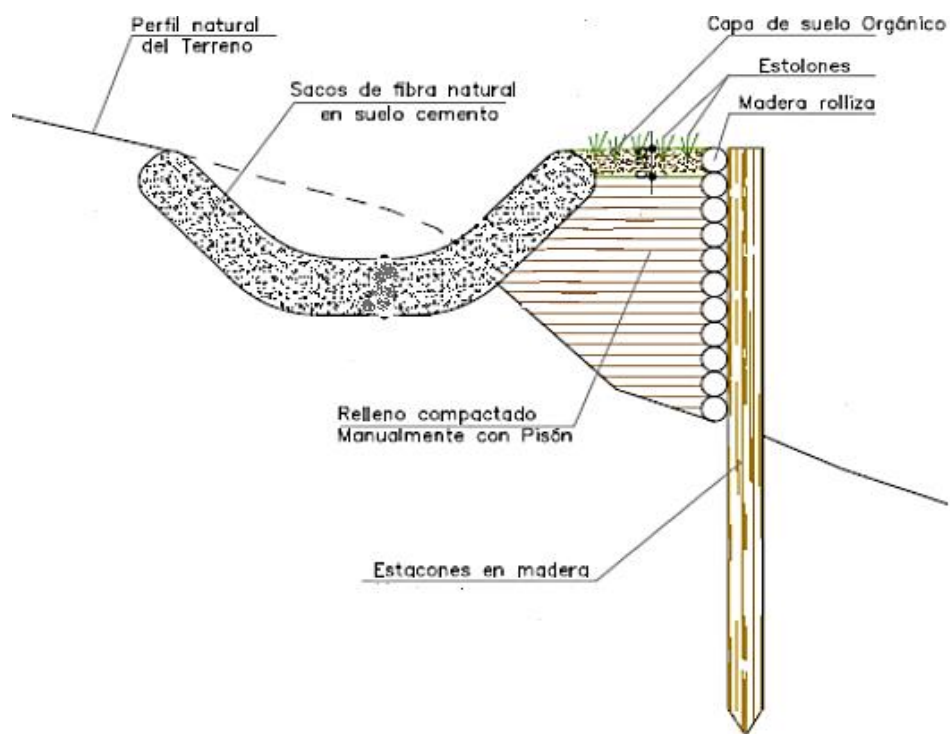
Estructura Cortacorrientes y Trinchos (Fuente: E.D. Ingeotécnia S.A.S)
